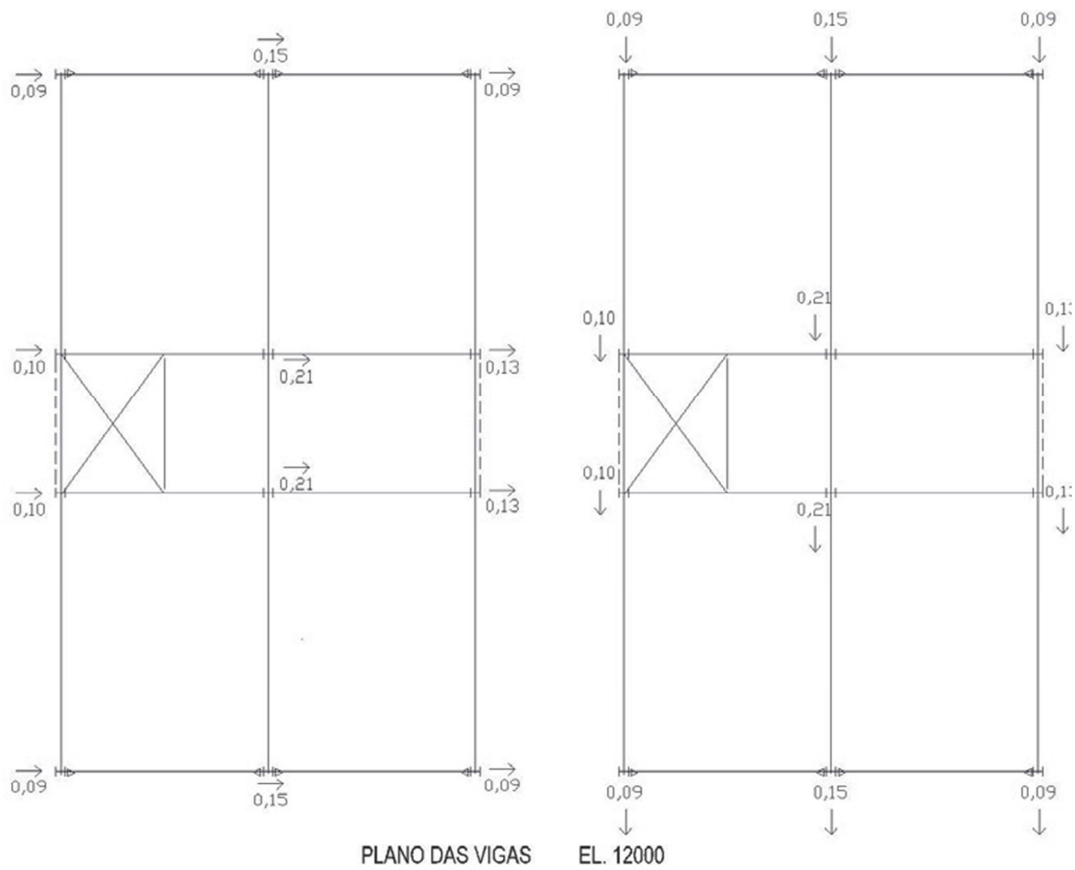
18 – Aplicação das Forças Nocionais no Plano das Vigas da Cobertura
